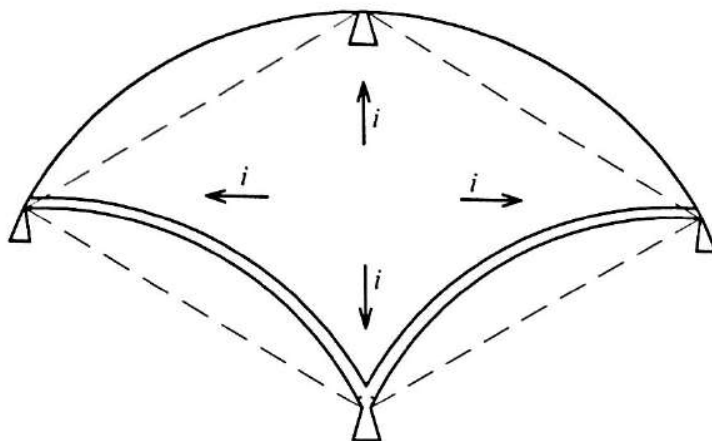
Пологая оболочка с контурными ребрами-арками, опирающимися на фундаменты по углам прямоугольного плана
